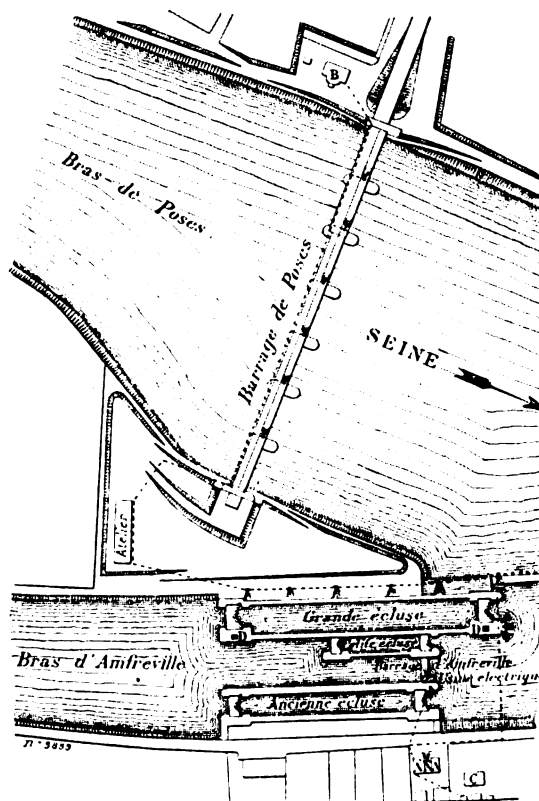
Plan général des écluses d'Amfreville et du barrage de Poses.
